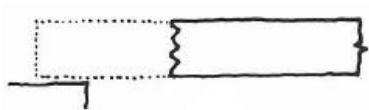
Corte da cabeça da viga (Arriaga [21])
